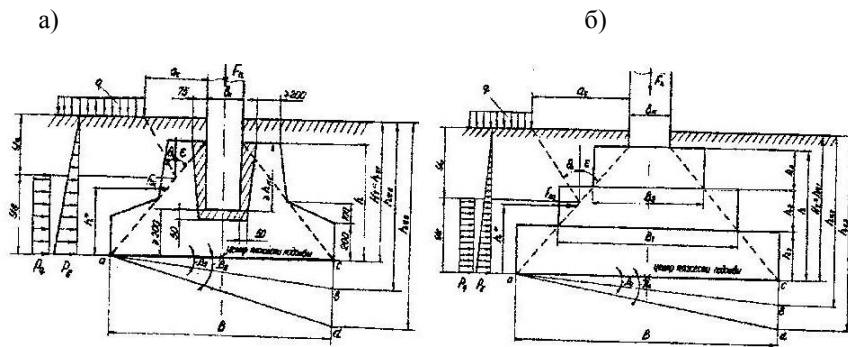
Схемы фундаментов: а) сборный цельный пирамидальный;
